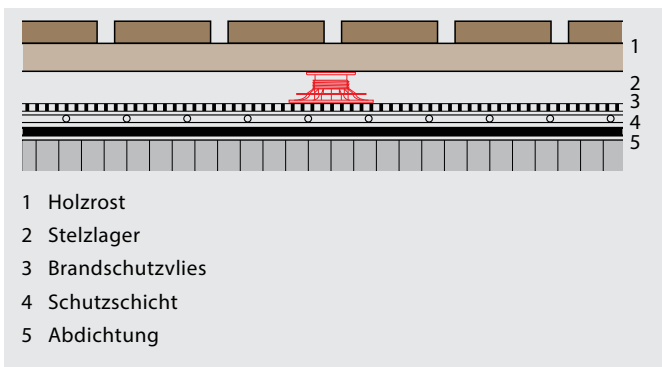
Systemaufbau eines Holzrostes über wärmeisolierte Flachdachkonstruktion.
